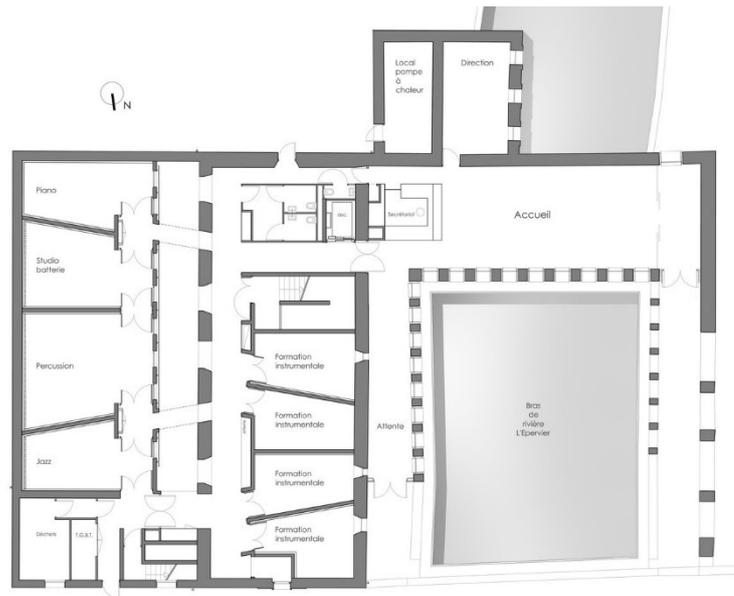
Planta Baixa 2º pavimento. Fonte: Archdaily, 2013.
